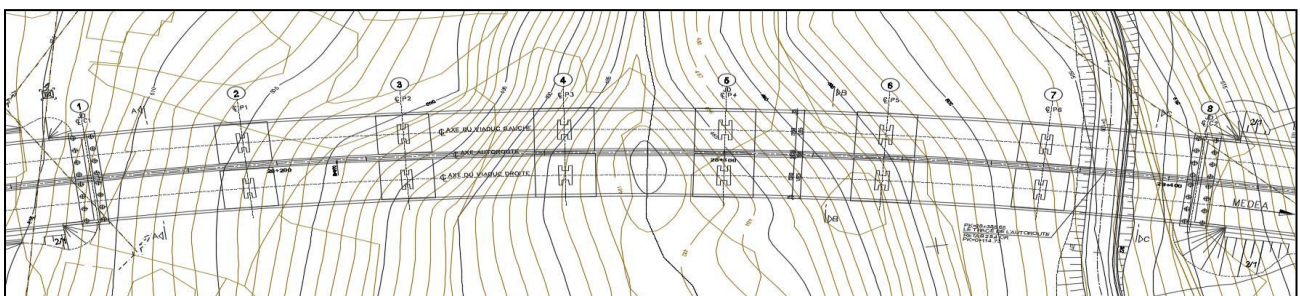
Le tracé en plan Élévations générales du viaduc (Coupes longitudinales)
